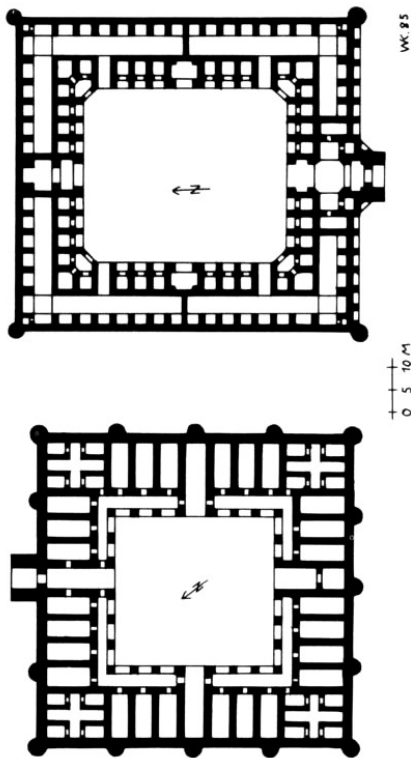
Planta tipo de um Caravançarai, em persa palácio de caravanas (UNESCO, 2018).
